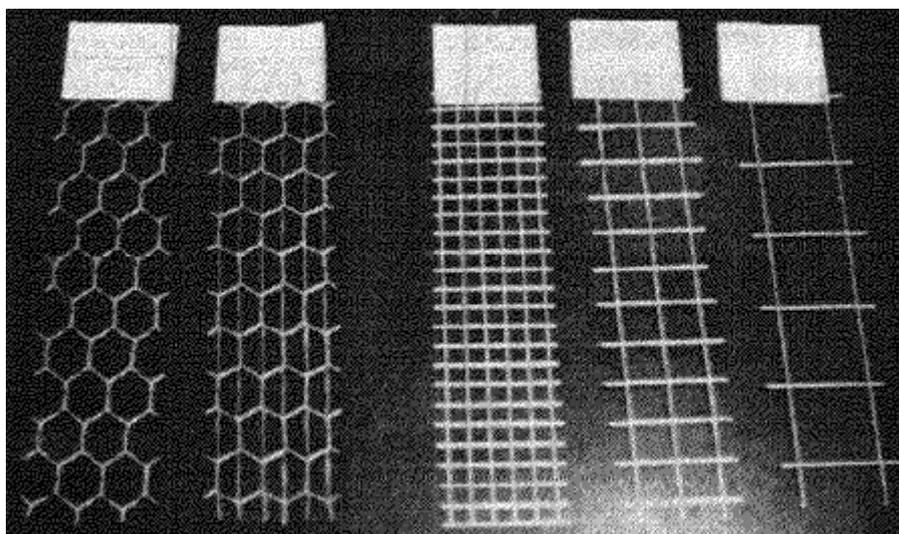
Tipos de mallas de alambre empleadas en Estructuras de Ferrocemento
